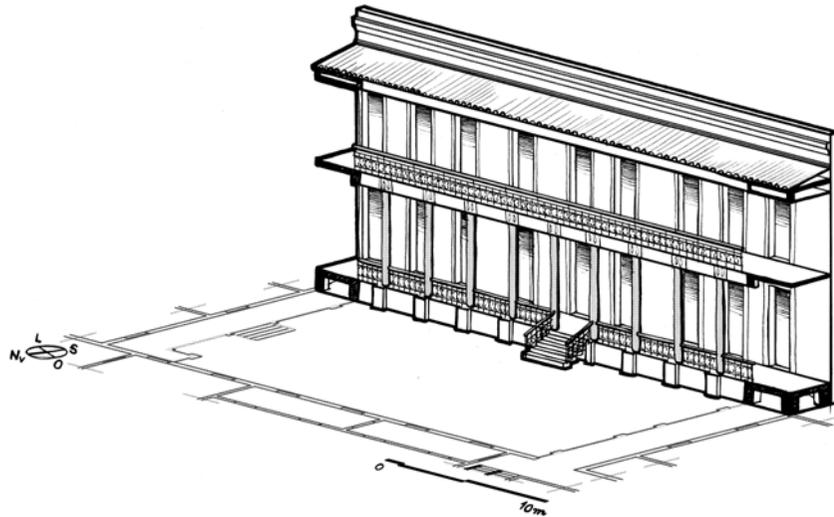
Estudo dos planos verticais, fachada Sudeste do pátio interno do CPIX.
